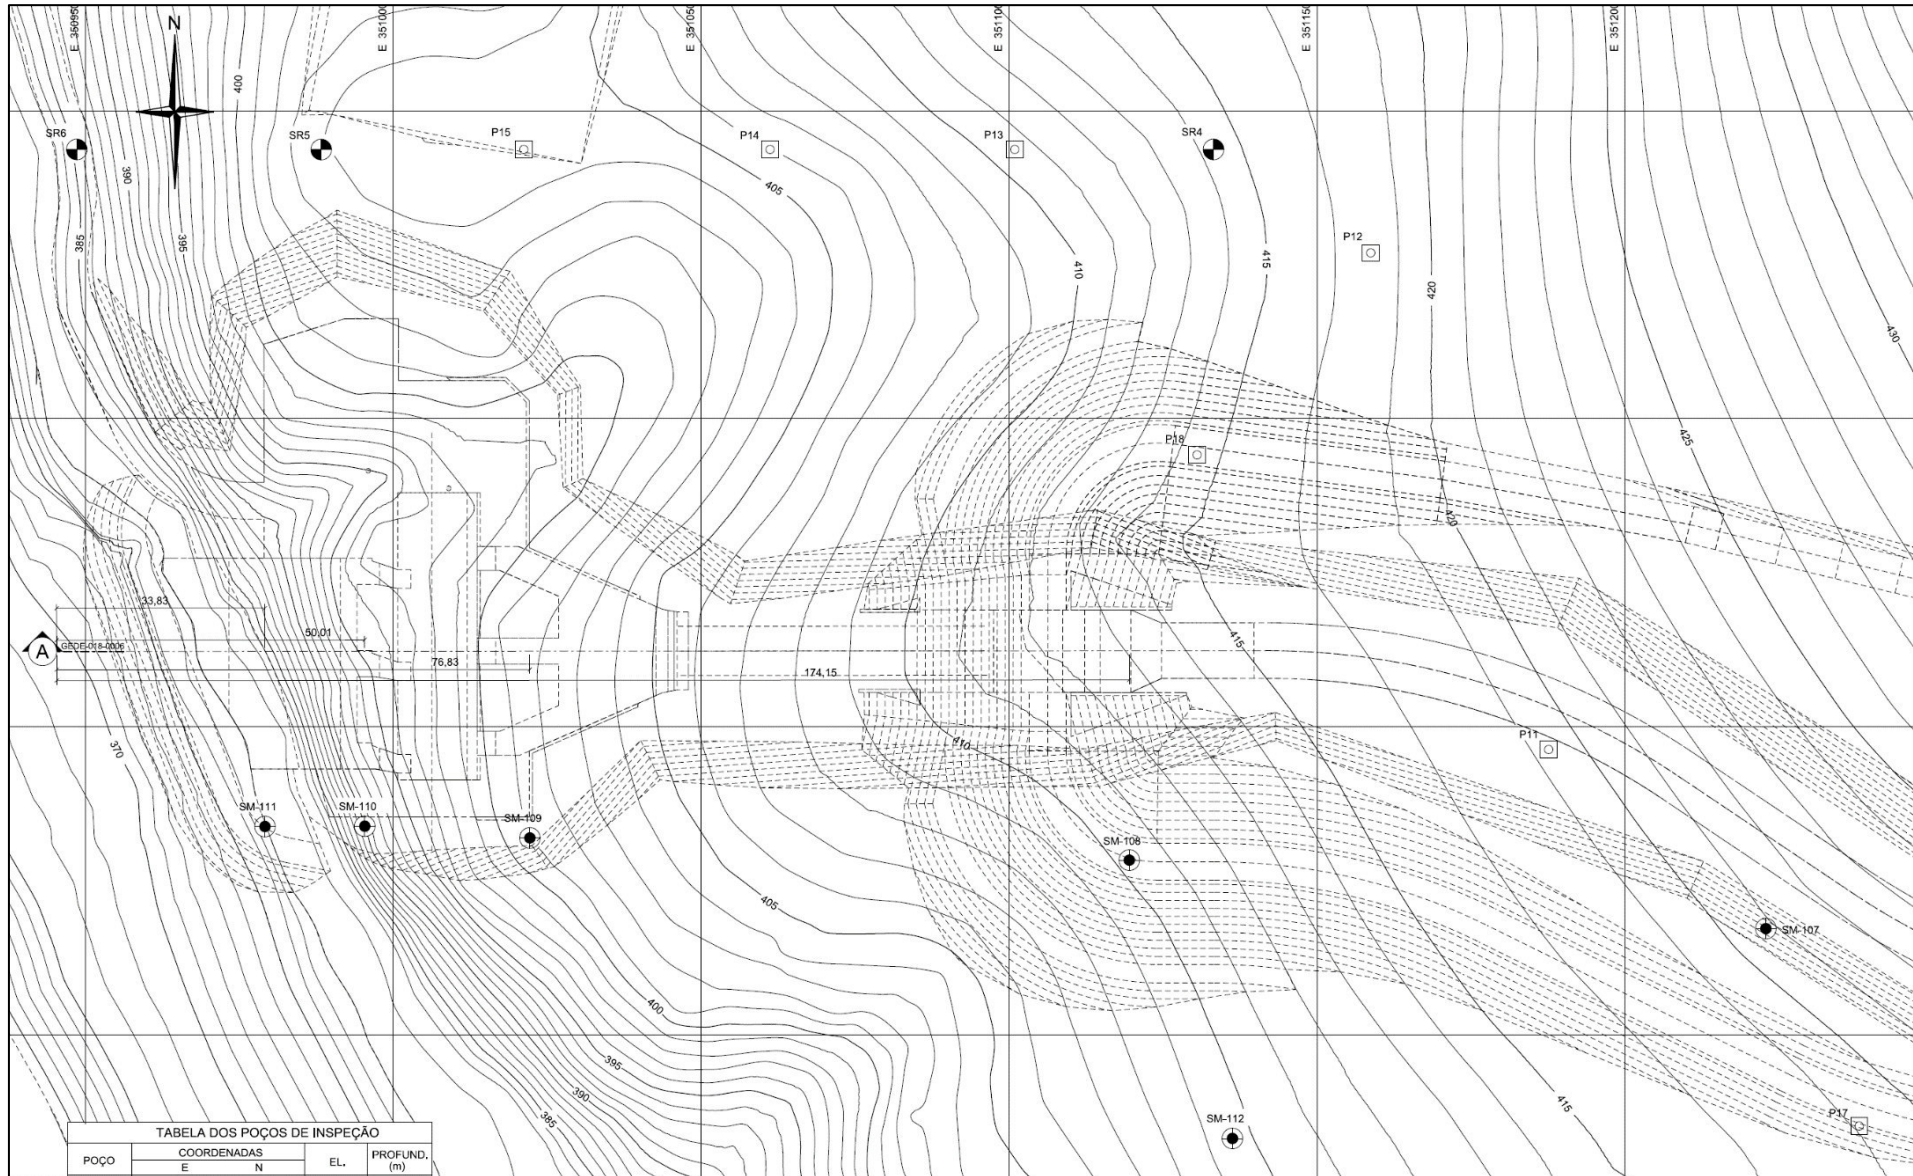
Planta de localização de sondagem na área do circuito de adução
